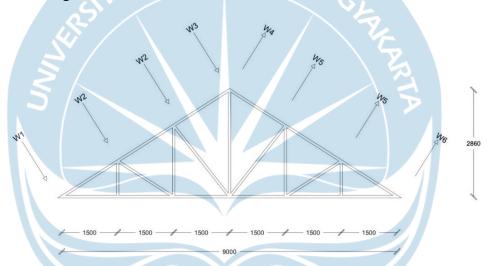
Beban Kuda-kuda Bangunann Edukasi A
